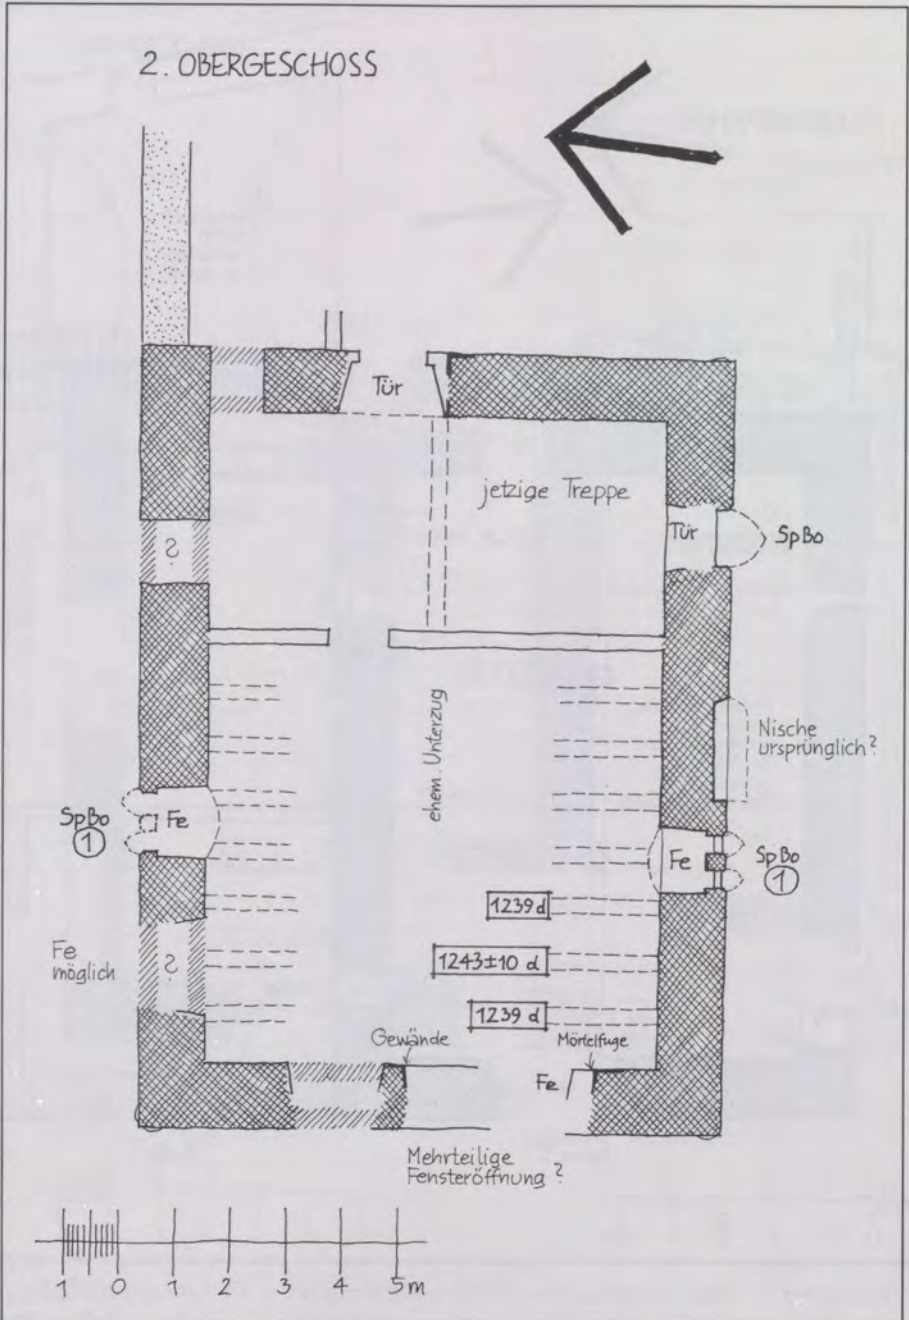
Grundriß 2. Obergeschoß. Legende siehe Ergeschoß. SpBo 2 siehe Abb. 10
